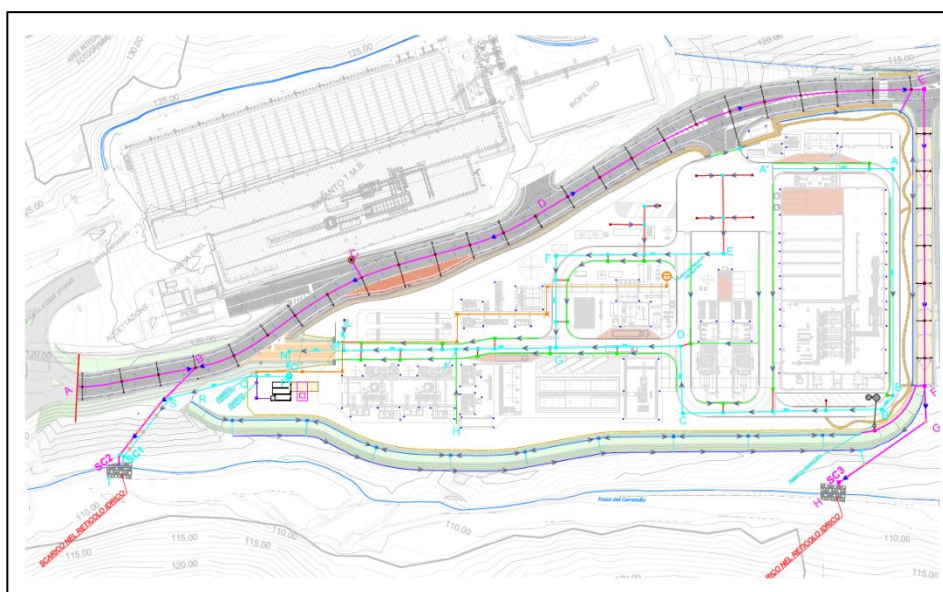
/5 - Andamento planimetrico rete di drenaggio interno
